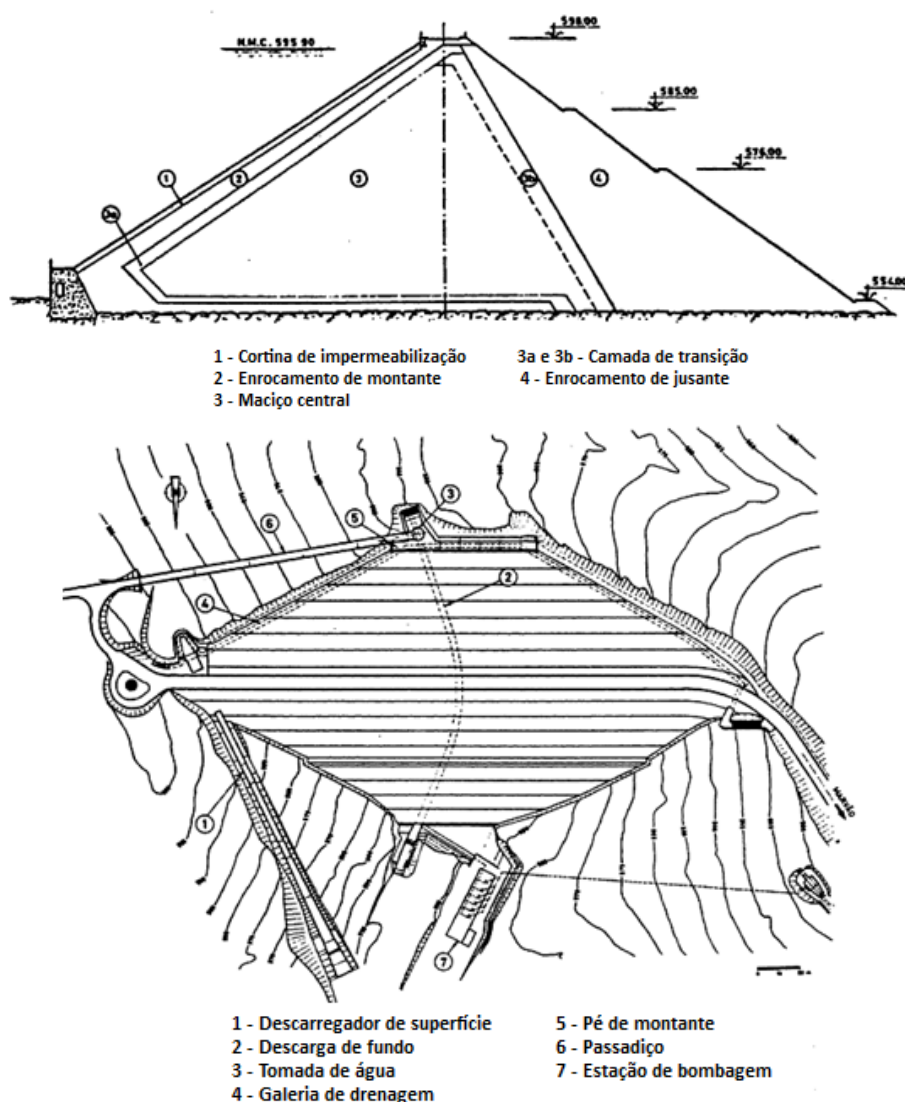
Planta e perfil transversal da barragem da Apartadura (adaptado de Silva Gomes *et al.*, 1995)
